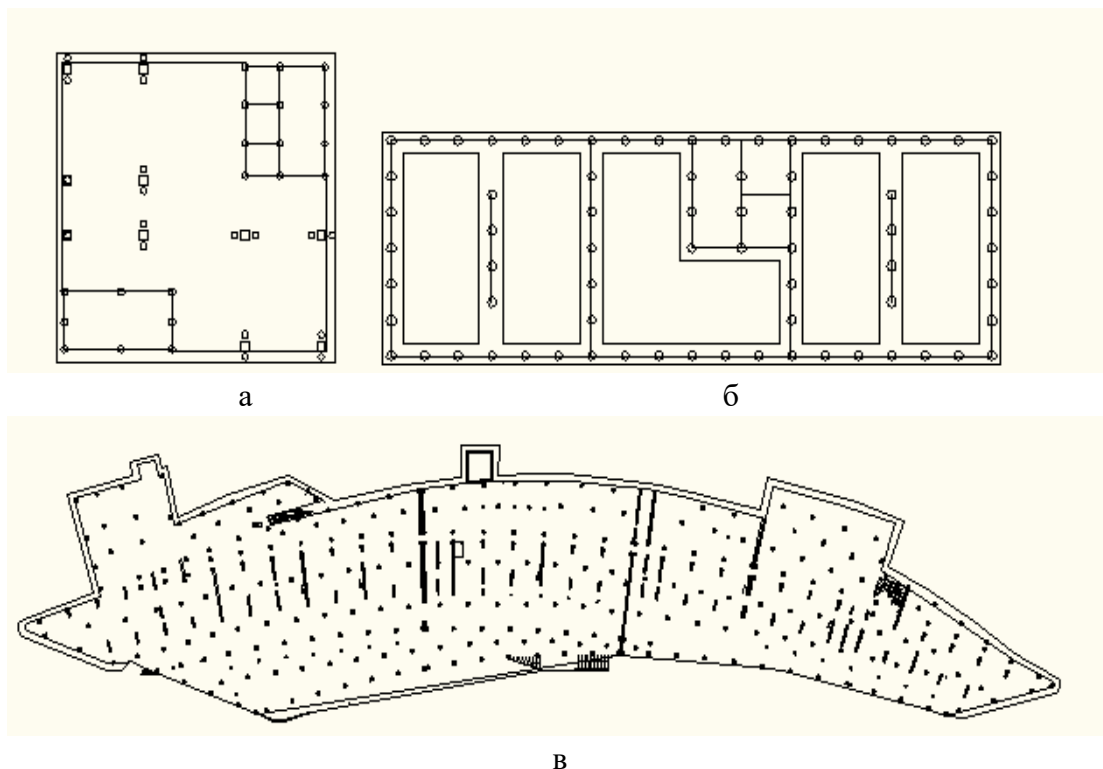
Конструктивні схеми досліджуваних будівель: а - десятиповерхова будівля з основними несучими елементами колонами; б - шістнадцяти поверхова будівля з основними несучими елементами стінами; в - восьмиповерхова будівля з основними несучими елементами колонами та пілонами
